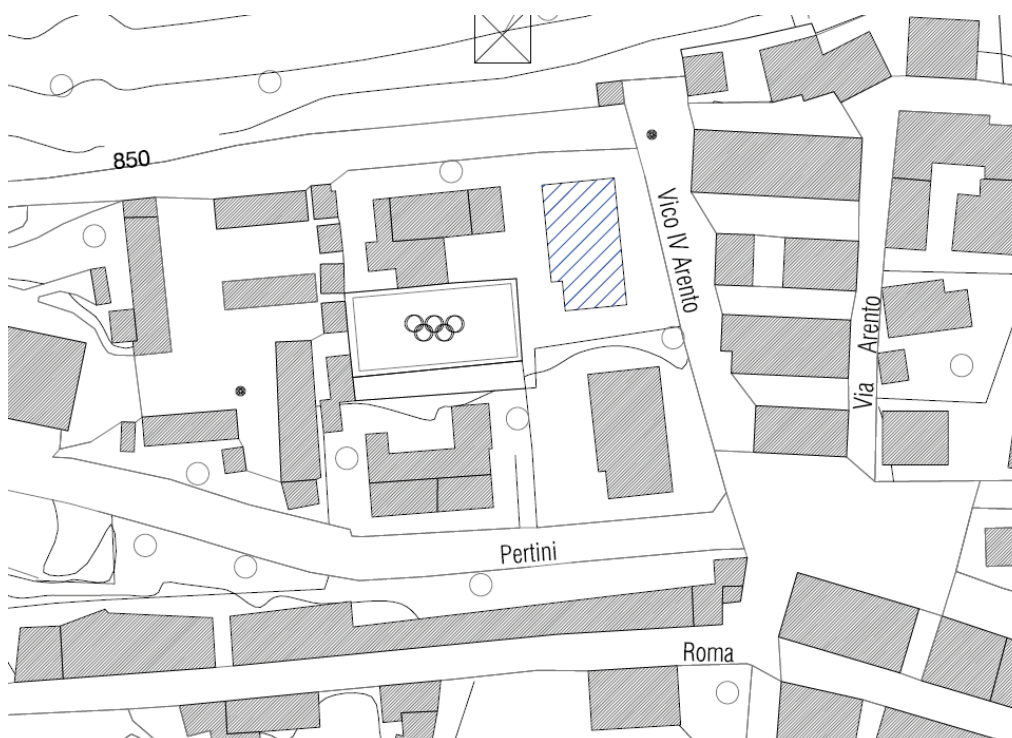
Planimetria generale dell'Intero Plesso Scolastico
